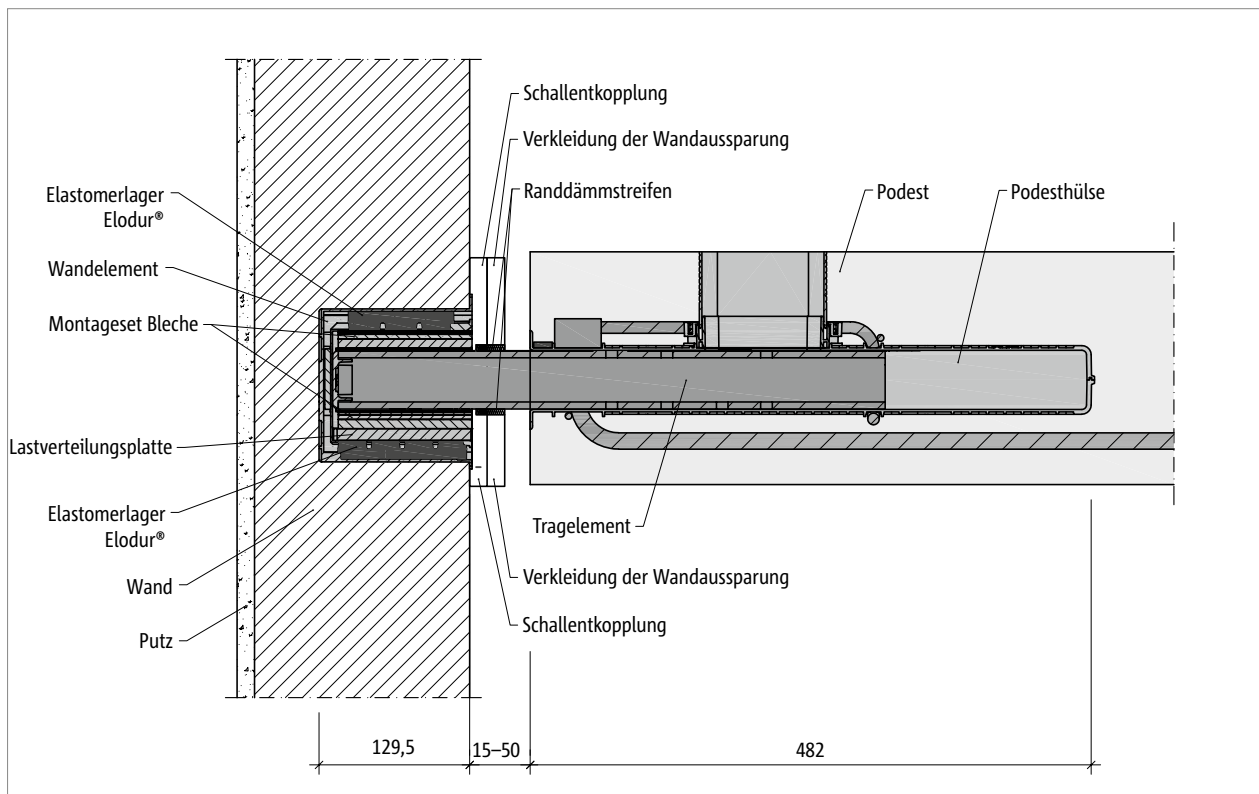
Tronsole® M: Einbauschnitt mit Fertigteilpodest und Luffuge
